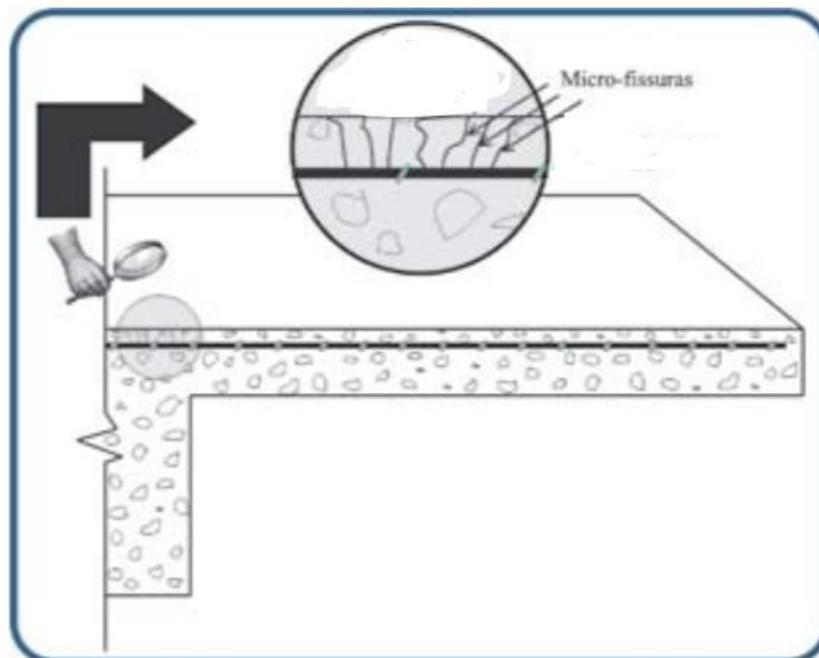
Fissuras causadas por flexão em viga contínua.
